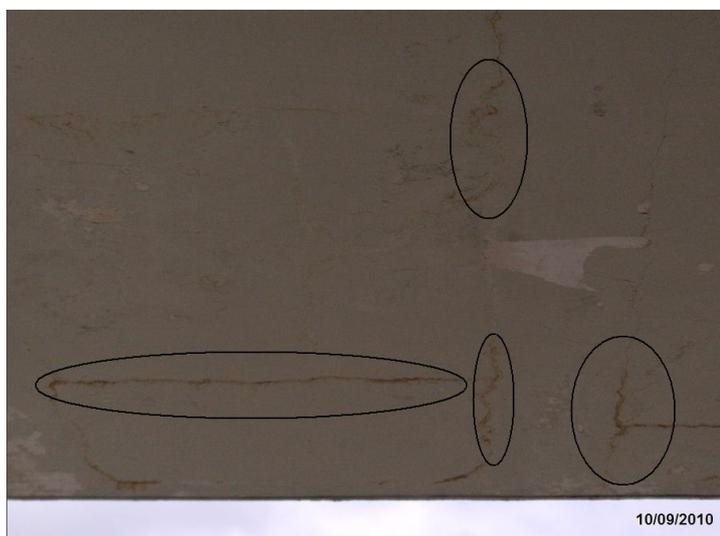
Presença de fissuras com manchas de tonalidade marron-avermelhada.
